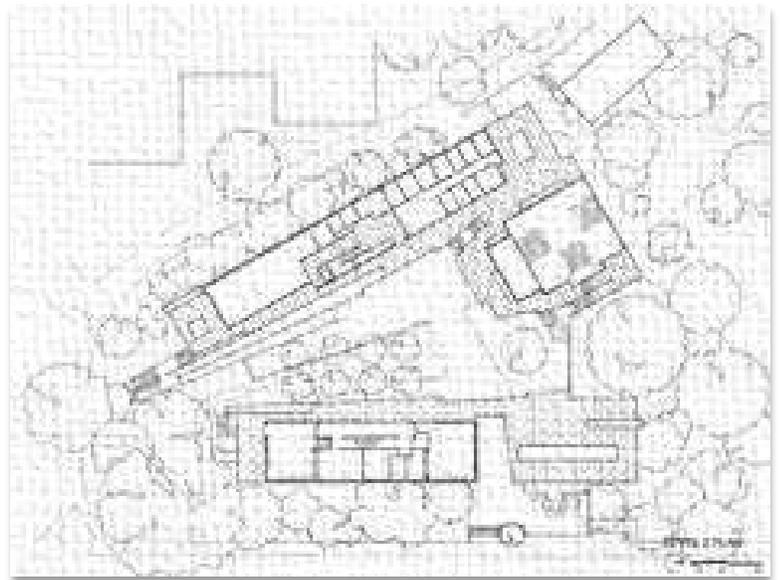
Planta Conjunto Arquitectónico Mattin Arts. Center
